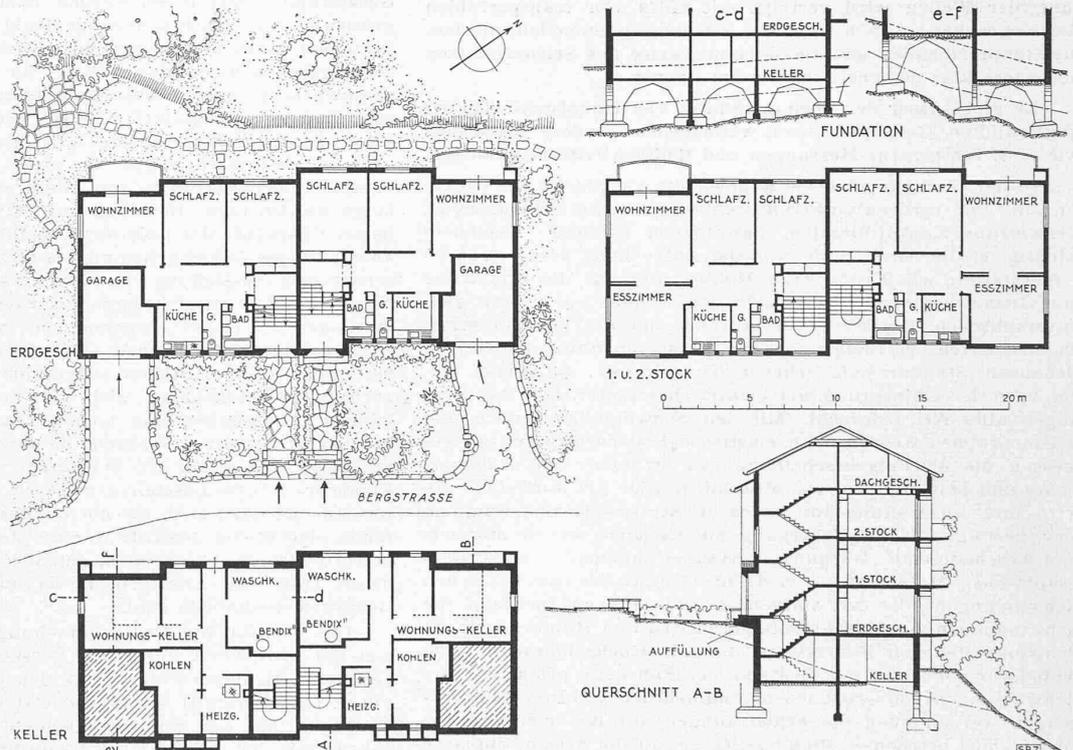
Doppel-Mehrfamilienhaus an der Bergstrasse in Zürich. — Grundrisse und Schnitte, 1:400
